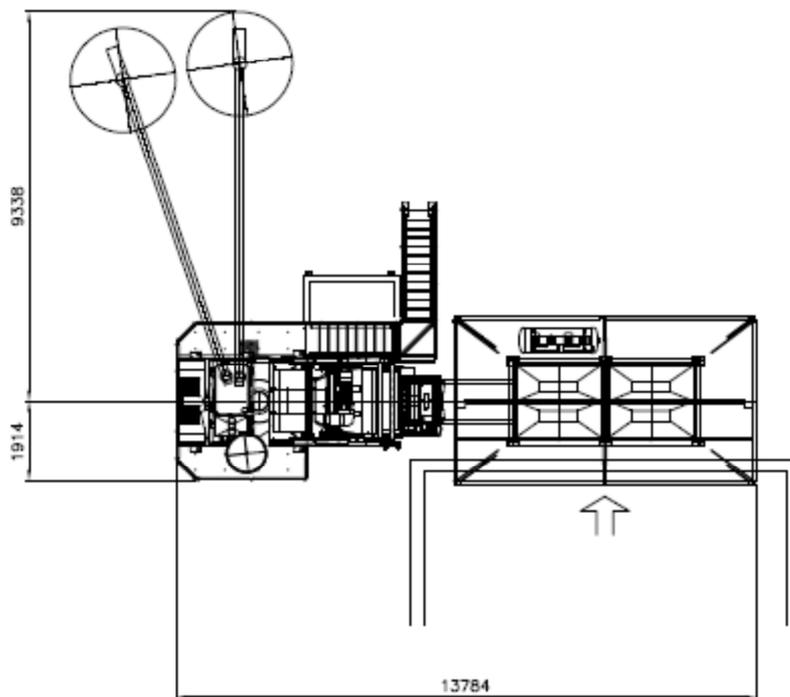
Sezioni tipo dell'impianto di betonaggio.
